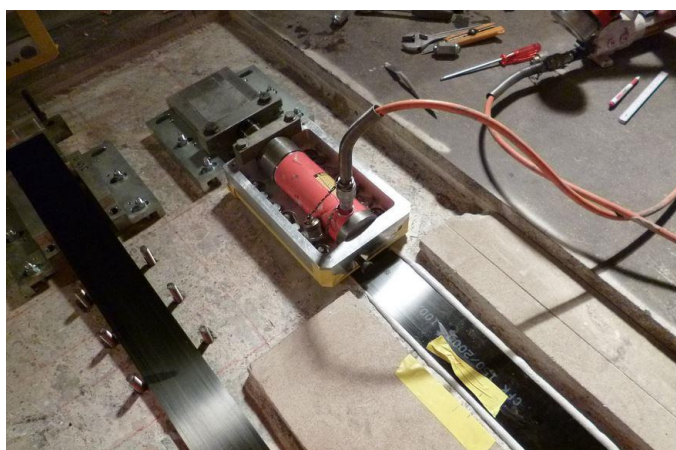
Utilização do pré-esforço (Reinforcement – Underground Garage, Coop, Kasparstrasse – Bern, Switzerland)
